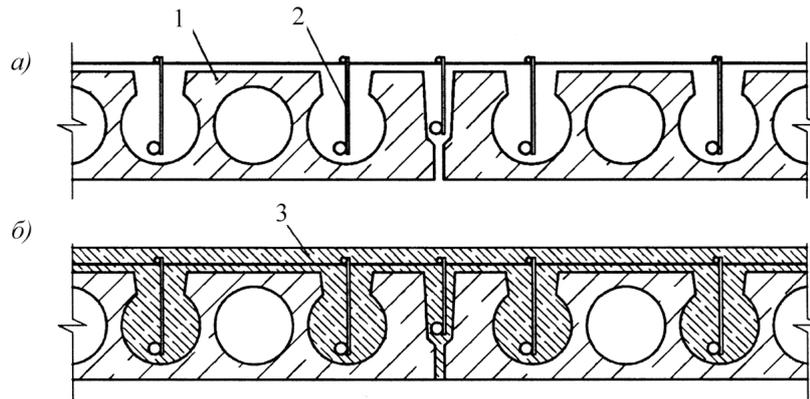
Ремонт и усиление монолитной плиты перекрытия с использованием литевых материалов
